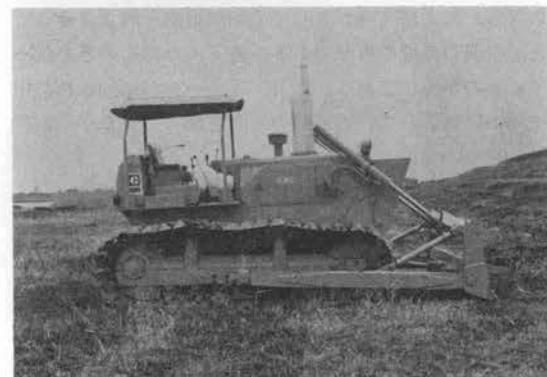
駆音対策型ブルドーザ D 6 C-90 B
